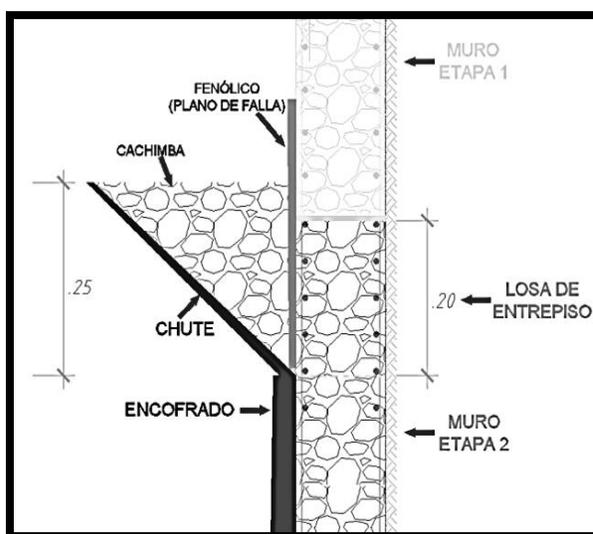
Esquema de chute y de plano de falla.
